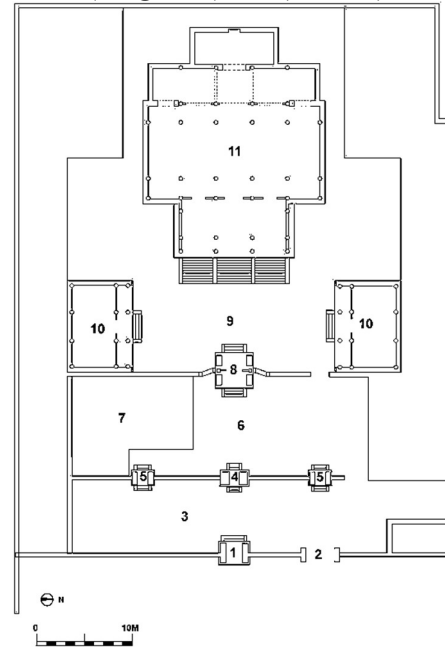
المسقط الأفقي لمسجد اتشانج بينج
